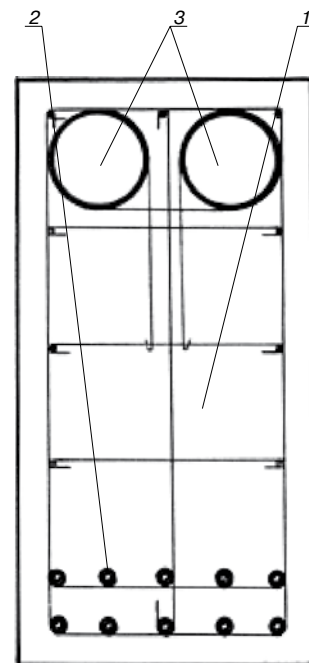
Схема поперечного сечения балки 750×1500 мм с двумя трубобетонными элементами круглого поперечного сечения в сжатой зоне. Обозначения см. рис. 6
